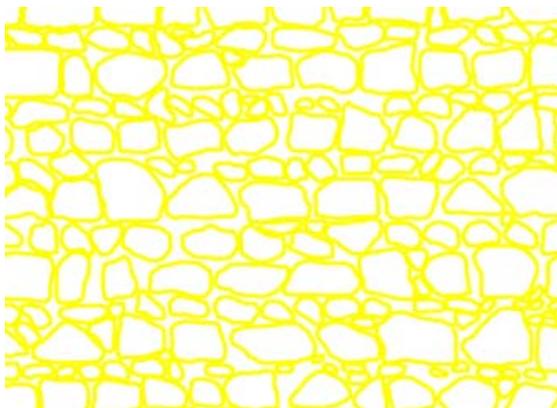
Pormenor U3^A. Levantamento arquitectónico (zona C). JMM
